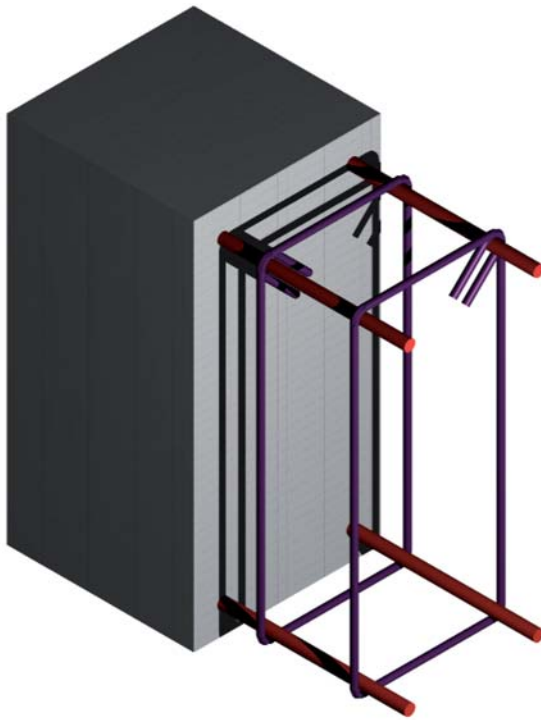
Extracción de parte del armado de una viga por inadecuados anclaje y recubrimiento.
